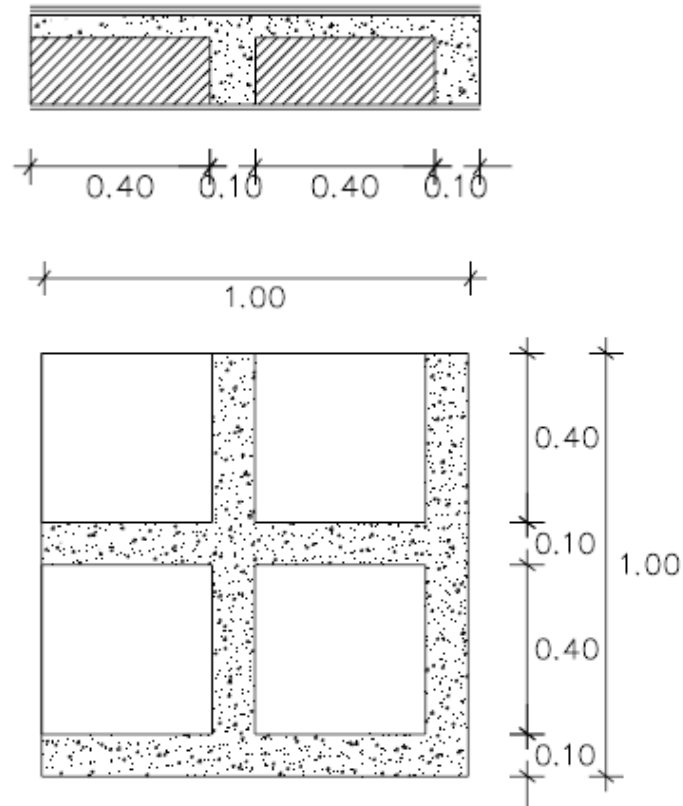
Detalle de losa y alivianamiento. Fuente: Guía para análisis y diseño estructural de edificios de hormigón armado. Elaborado por: Marco Benalcázar
